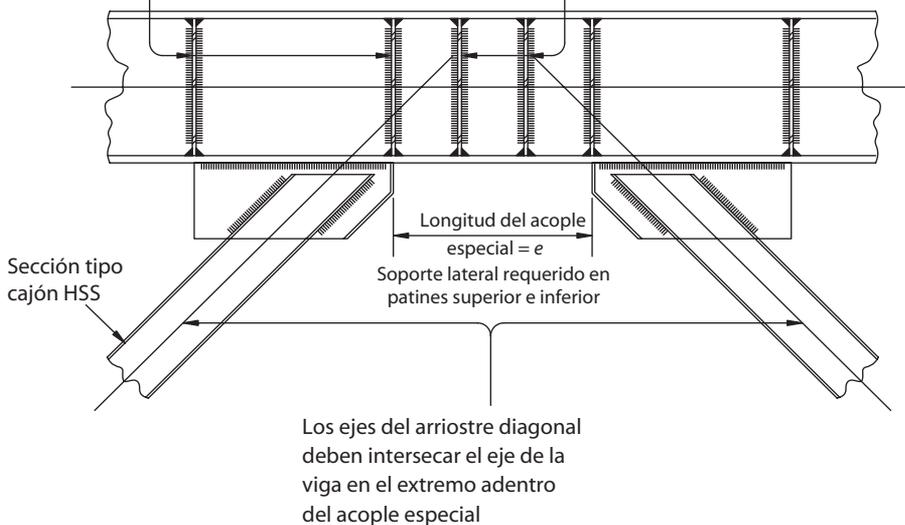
Detalles de *acoples especiales*, Ref.7.
